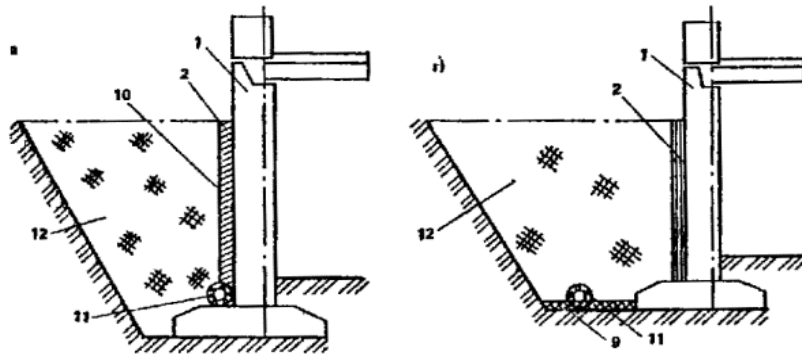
Пристенный дренаж: 1-защищаемое сооружение, 2-гидроизоляция, 10- плита из пористого бетона, 11-трубофильтр, 12-грунт обратной засыпки.
